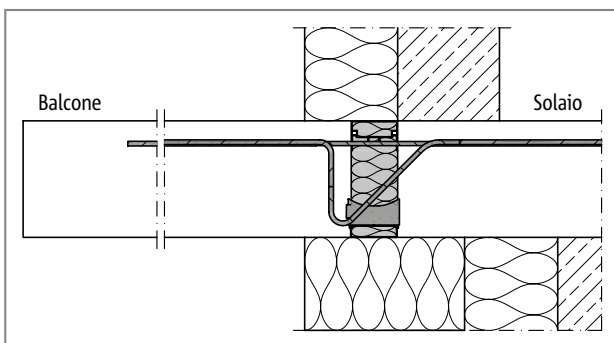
Schöck Isokorb® tipo K, raccordo indiretto a solaio con cappotto
